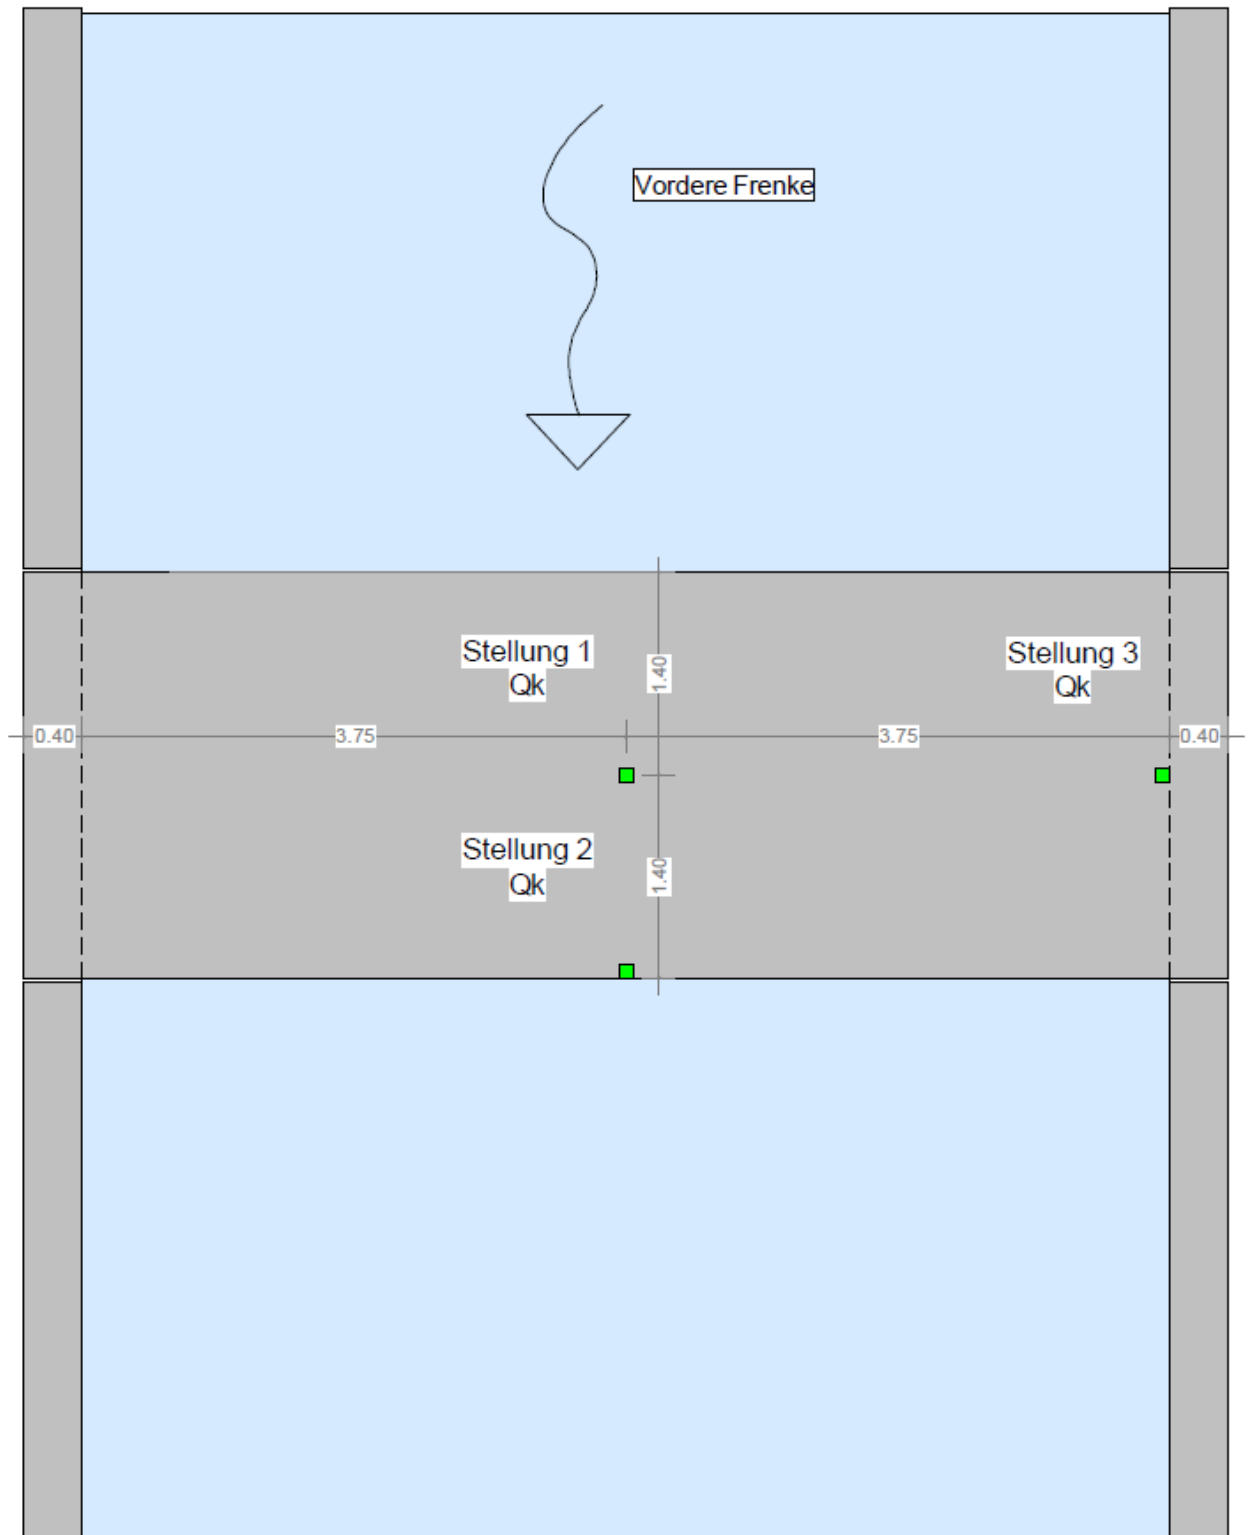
Die massgebende Laststellung für LM2 im Grundriss dargestellt
